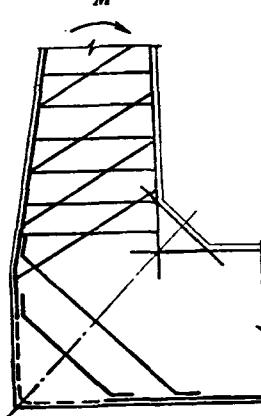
Схема армирования угловых сопряжений массивных железобетонных конструкций
